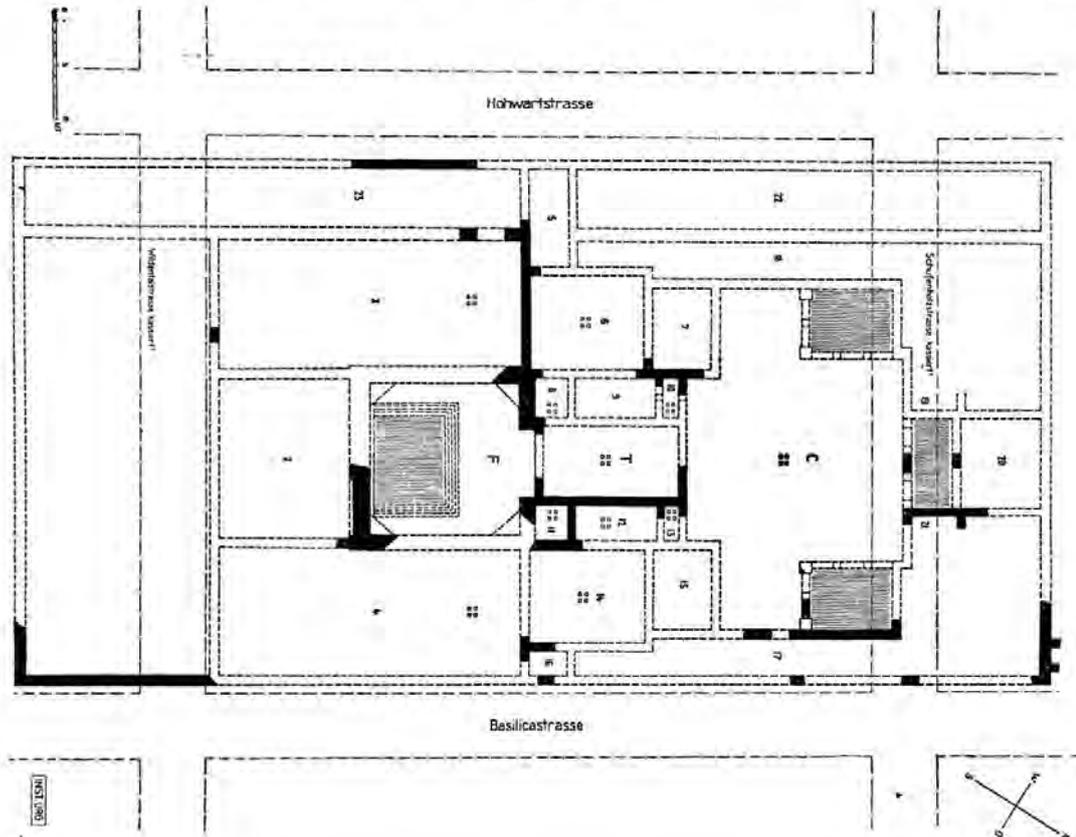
Augst. Grundriß der Zentralthermen. Ergänzungsversuch
